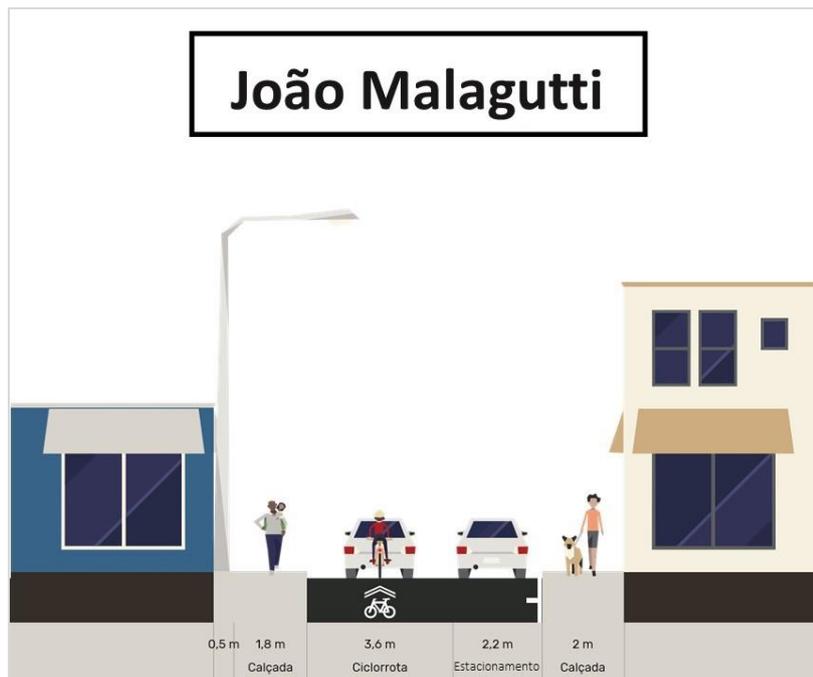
Proposta para a Rua João Malagutti. Fonte: Streetmix. Elaboração: Polo Planejamento.
